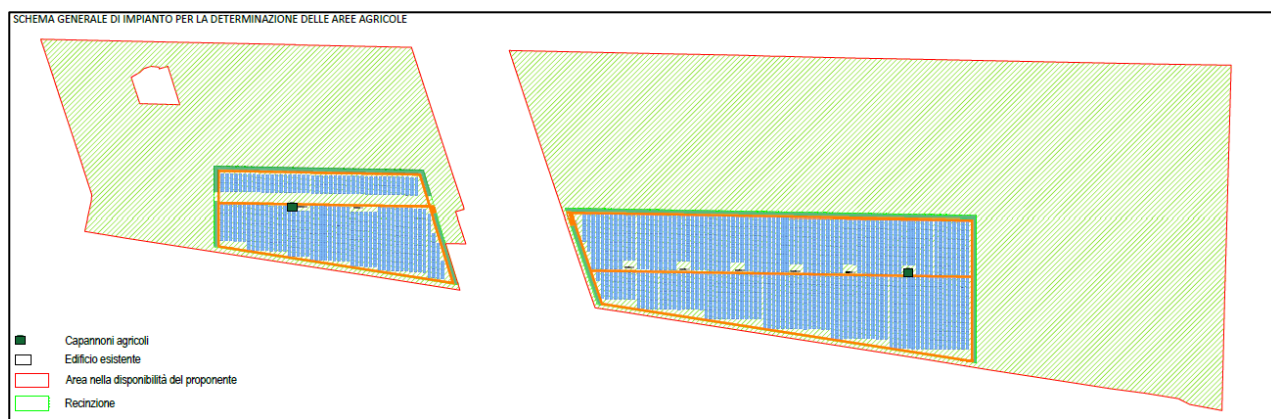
Layout di progetto e rispetto dei criteri di corretta installazione ai sensi della DAL 125/23
